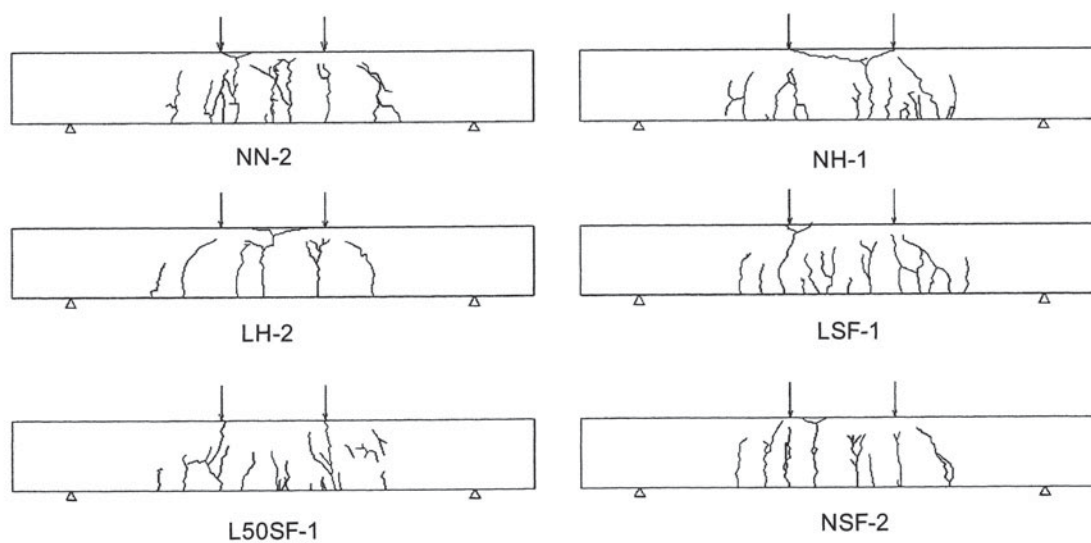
RCはり供試体のひび割れ状況³⁾
